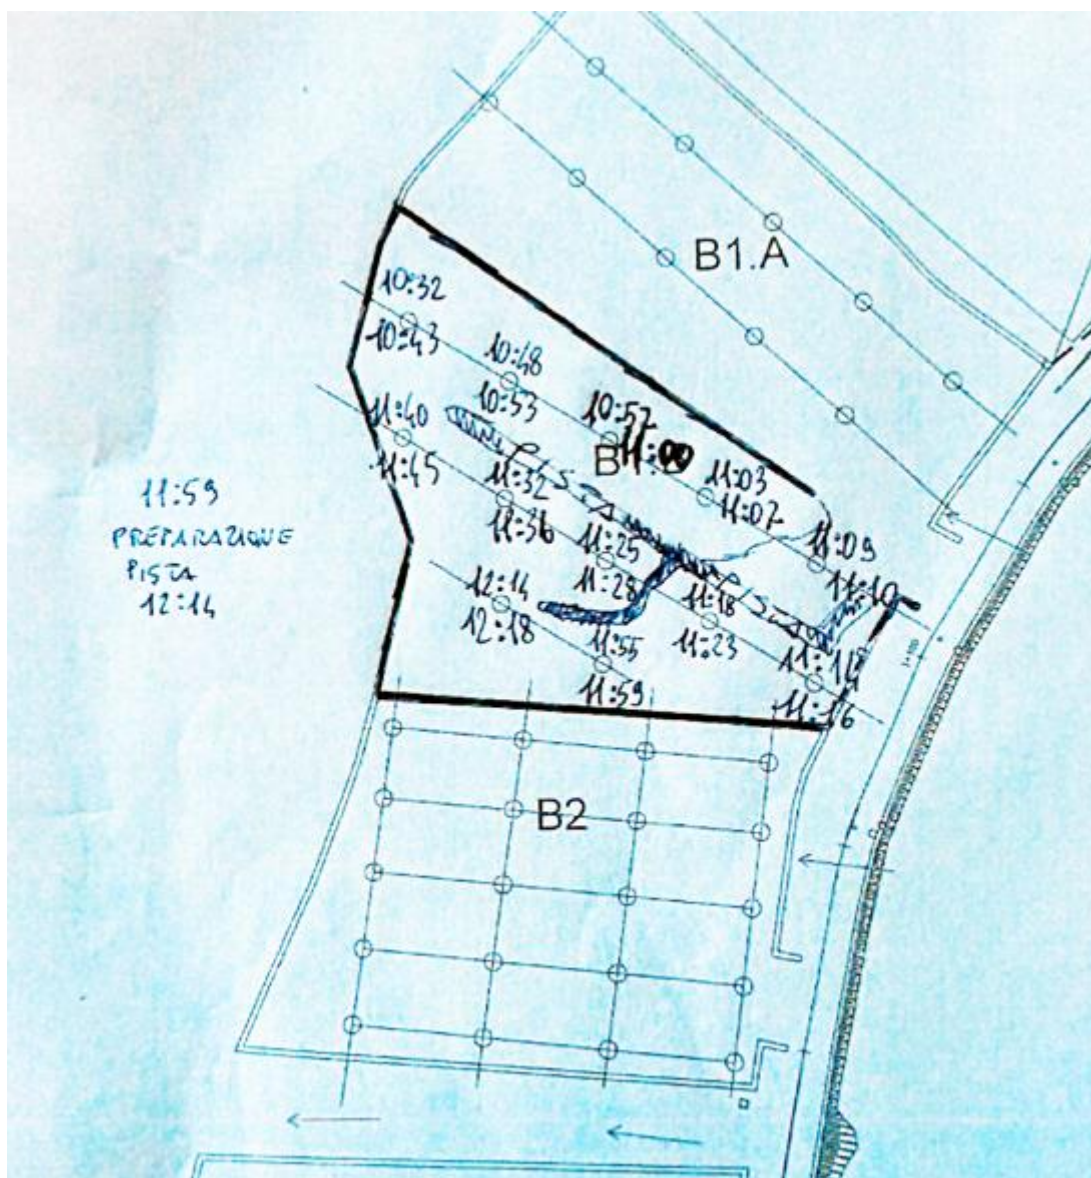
Planimetria di campo di Consorzio Florentia con rappresentata l'ubicazione delle verticali di campionamento, piazzola B1B.
